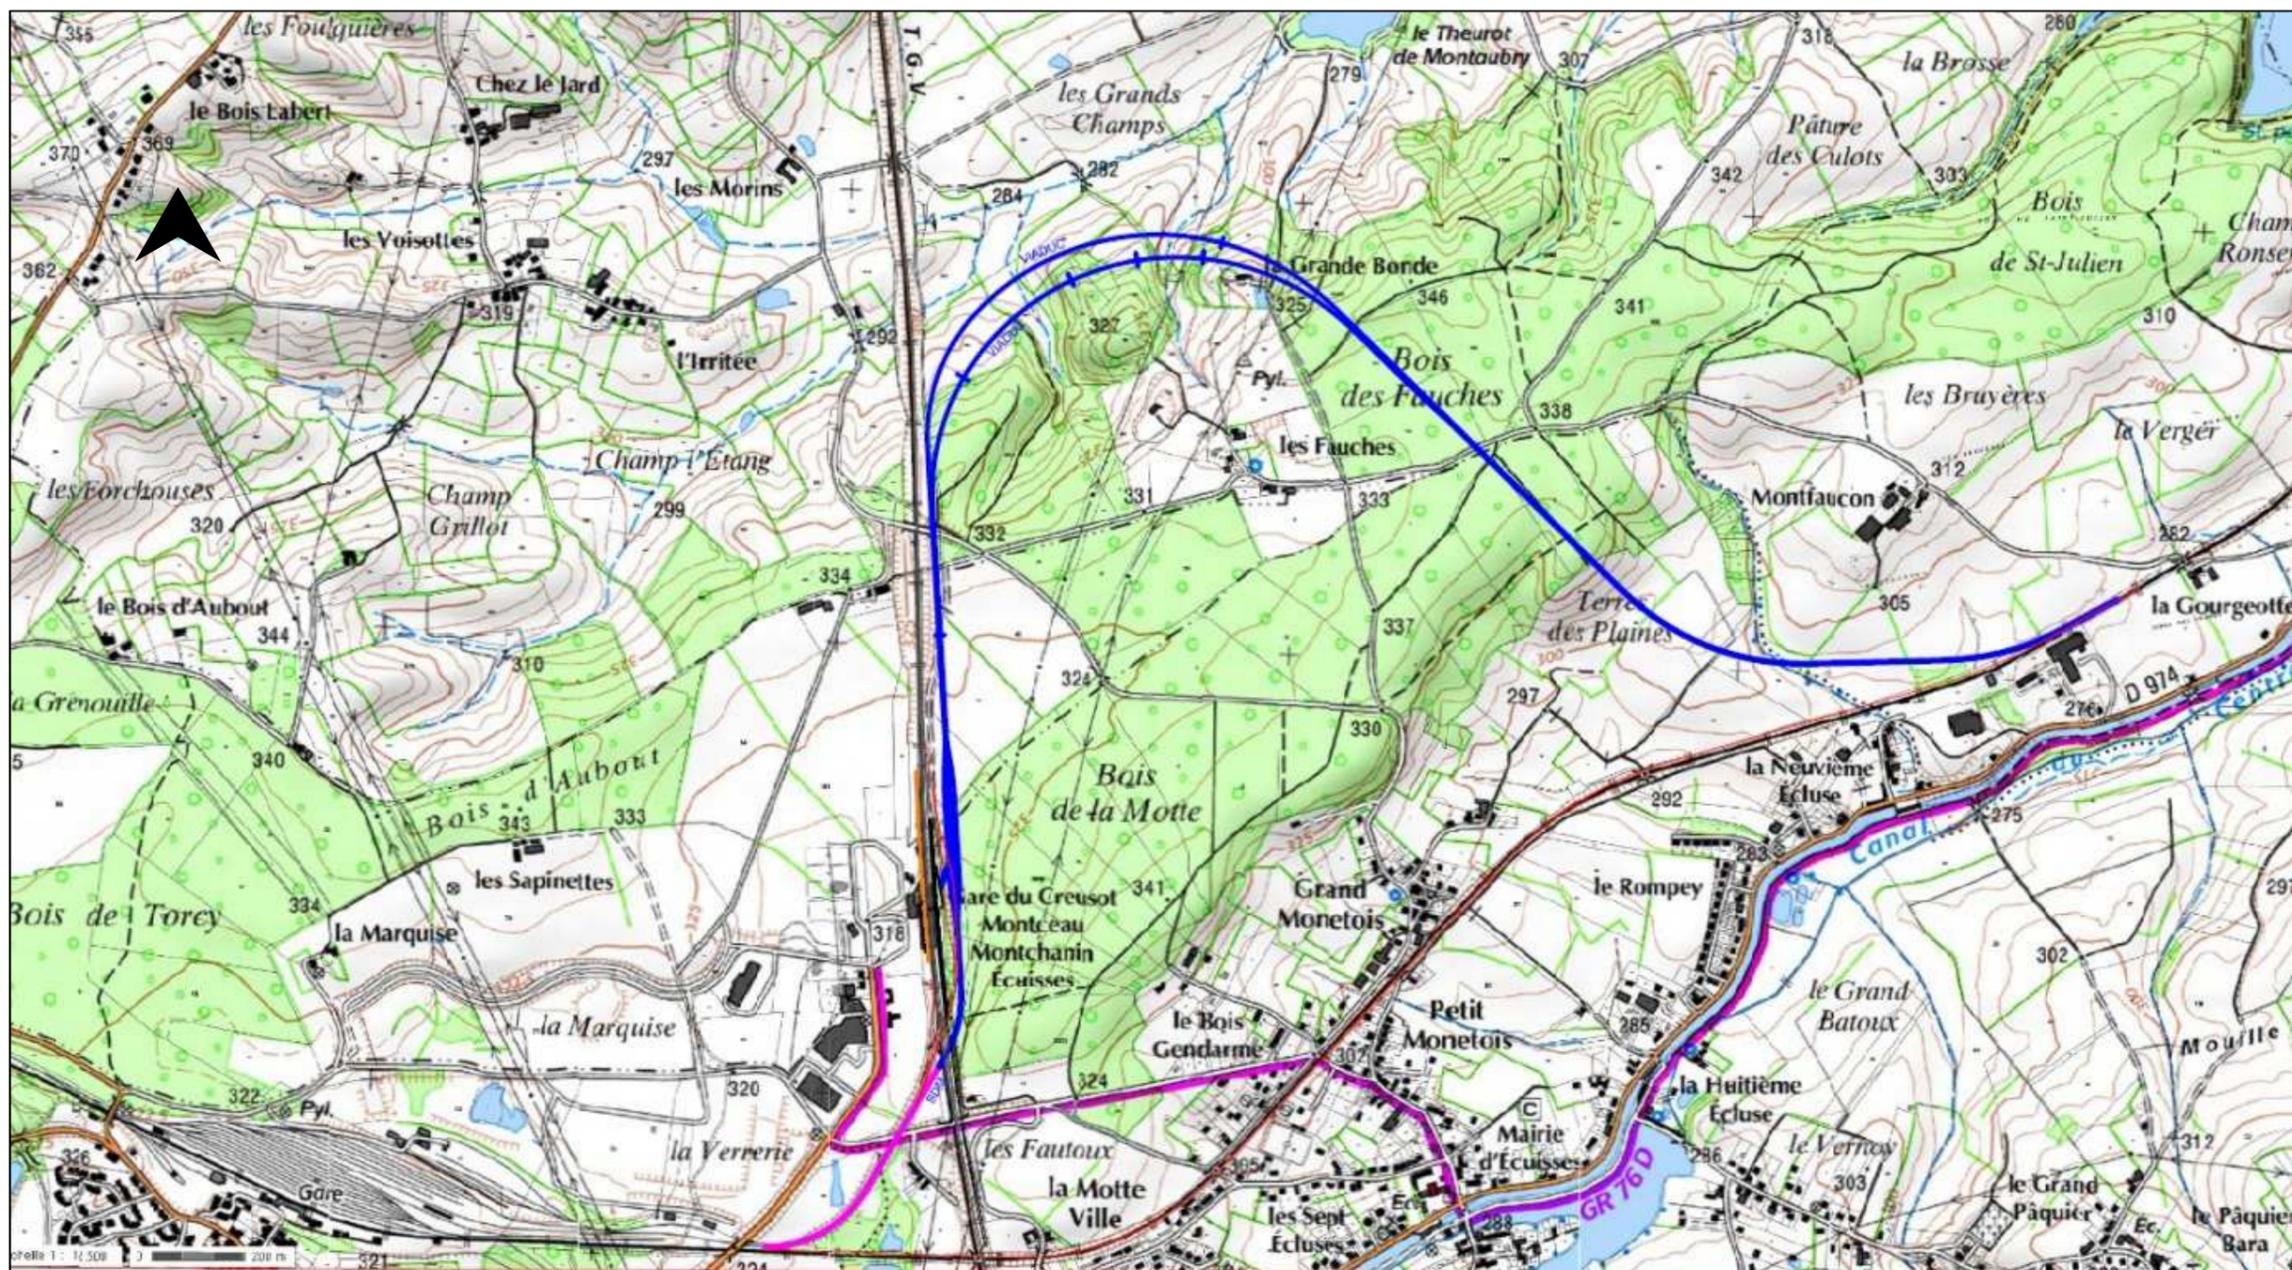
Tracé en plan de la solution à l'est (Fond IGN)
